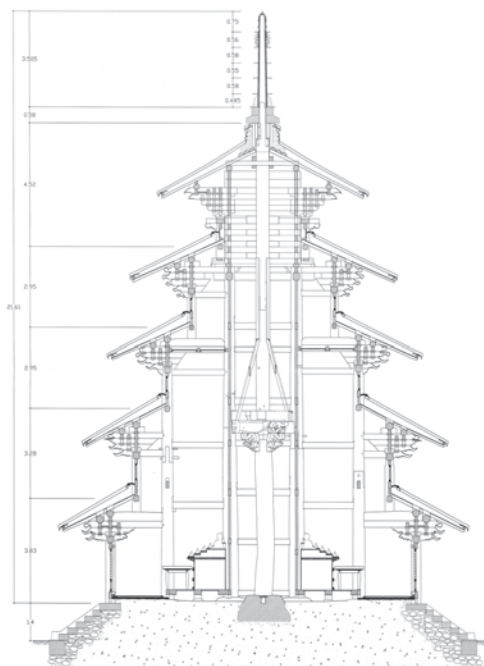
法住寺捌相殿 断面図 1 : 300
